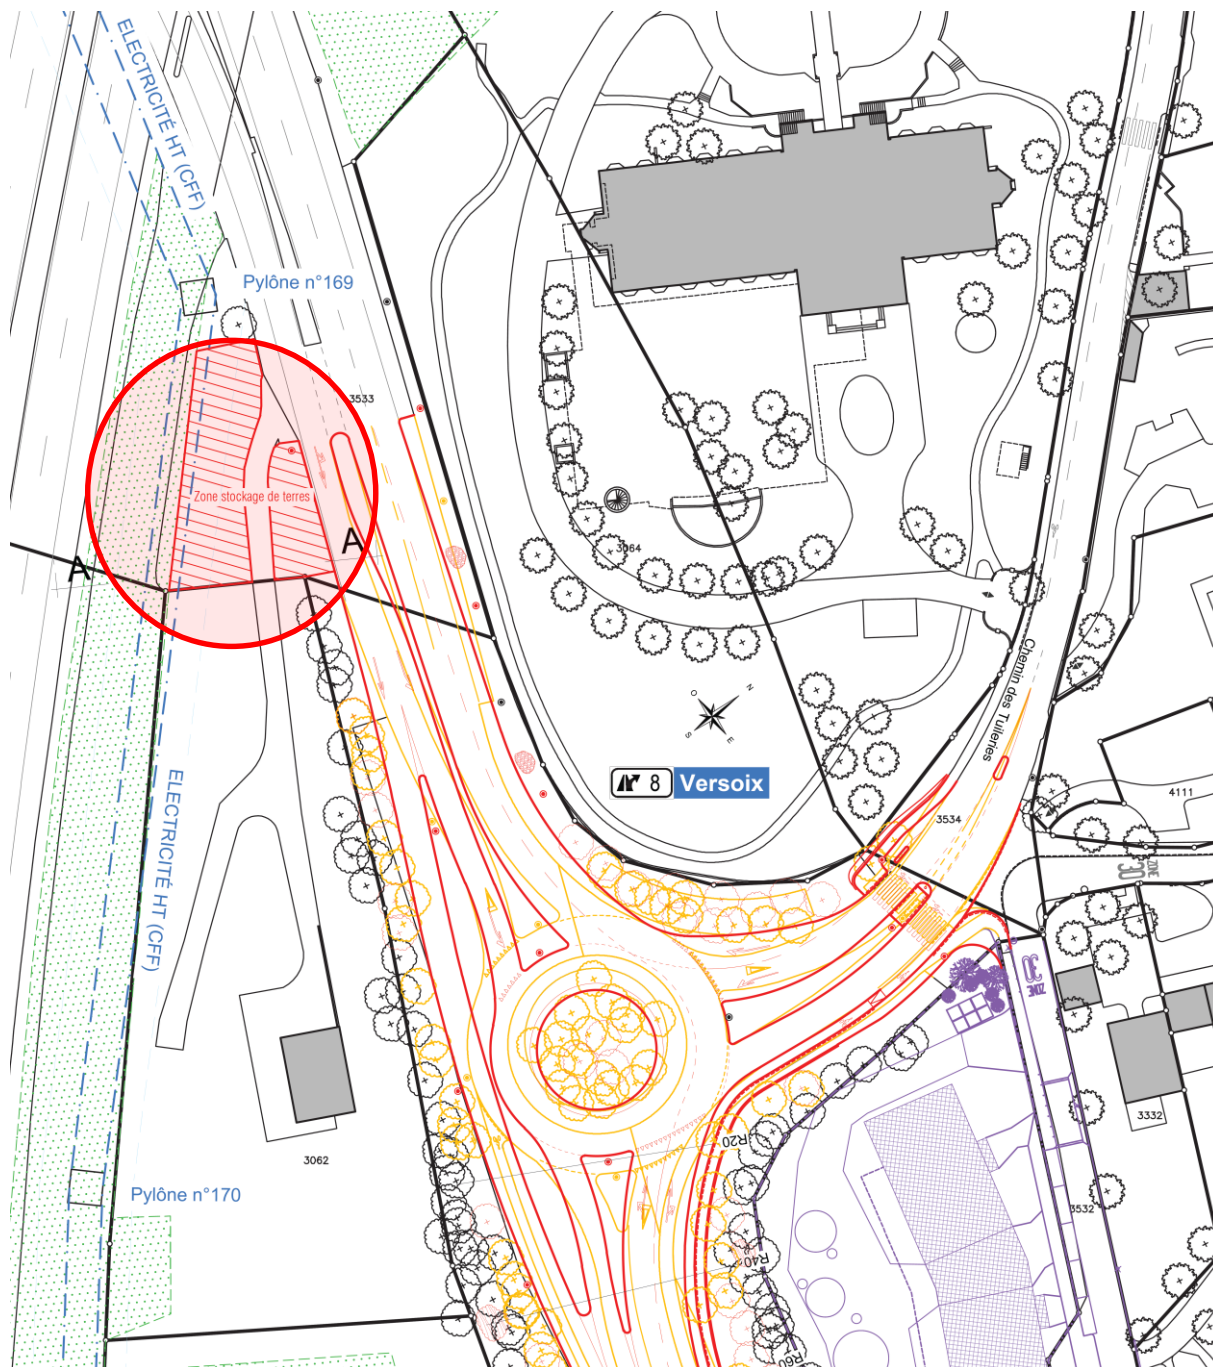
Extrait du plan de situation (source : Groupement VERO)
